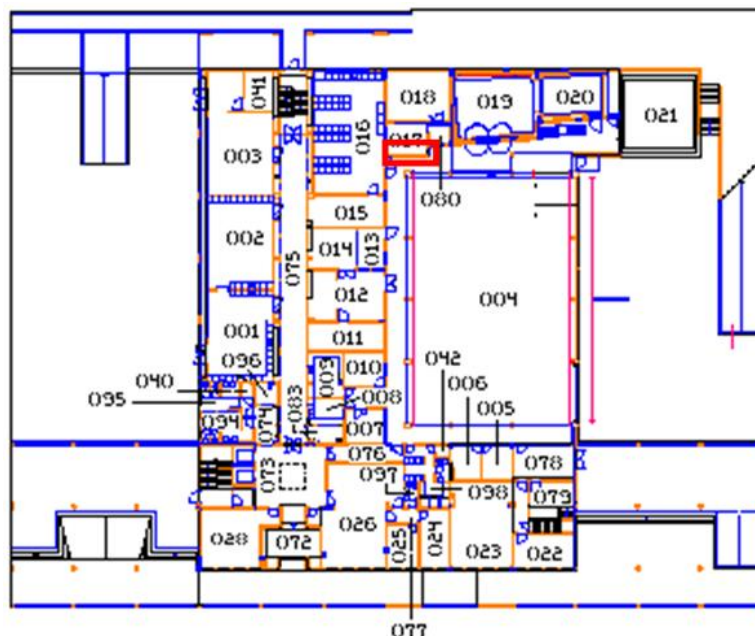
Planta do piso 0 do edifício H da FEUP com a indicação da parede analisada (adaptado de [71])
